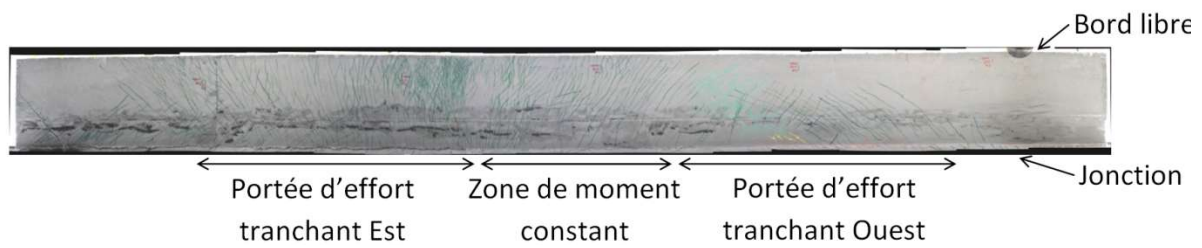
Relevé de fissures sur la table de la poutre BFUP B A (demi-aile nord, face inférieure)
